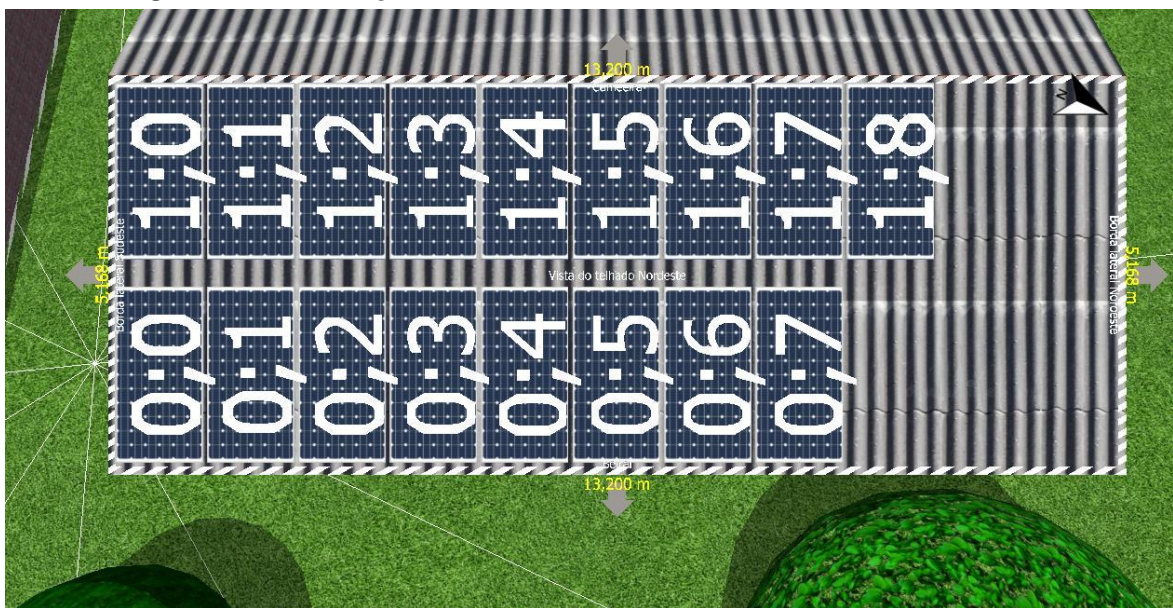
Estrutura de sustentação do telhado nordeste do galpão
